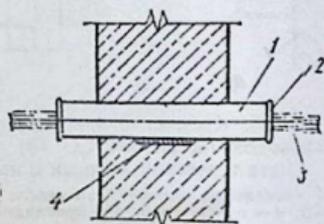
Открытый проход пластмассовых труб через стены и перекрытия:
